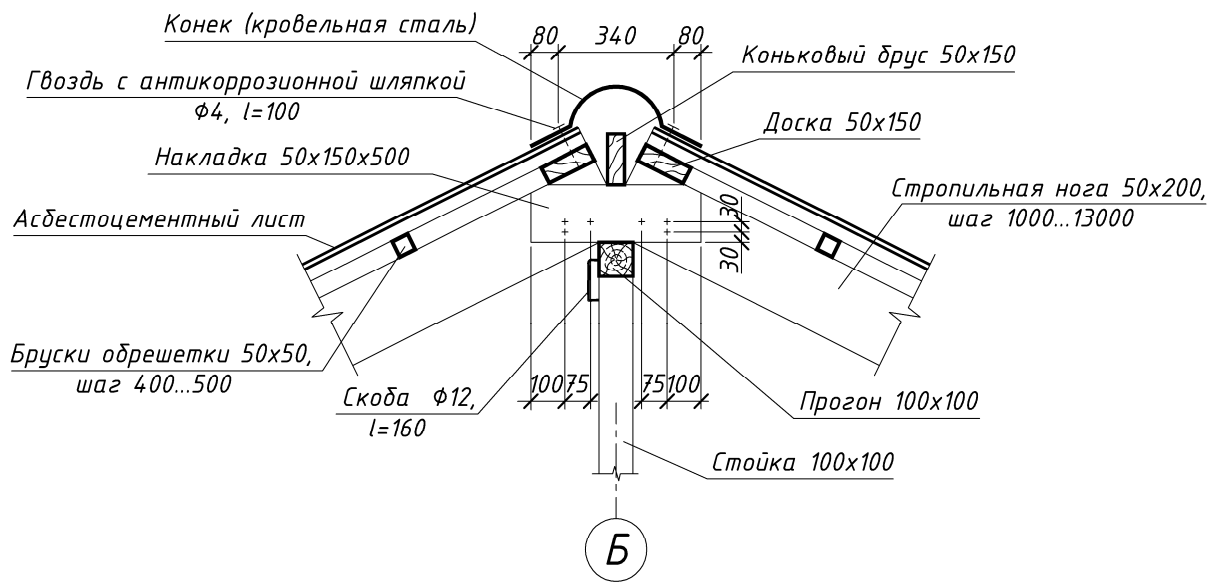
Коньковый узел стропильной крыши жилого дома
